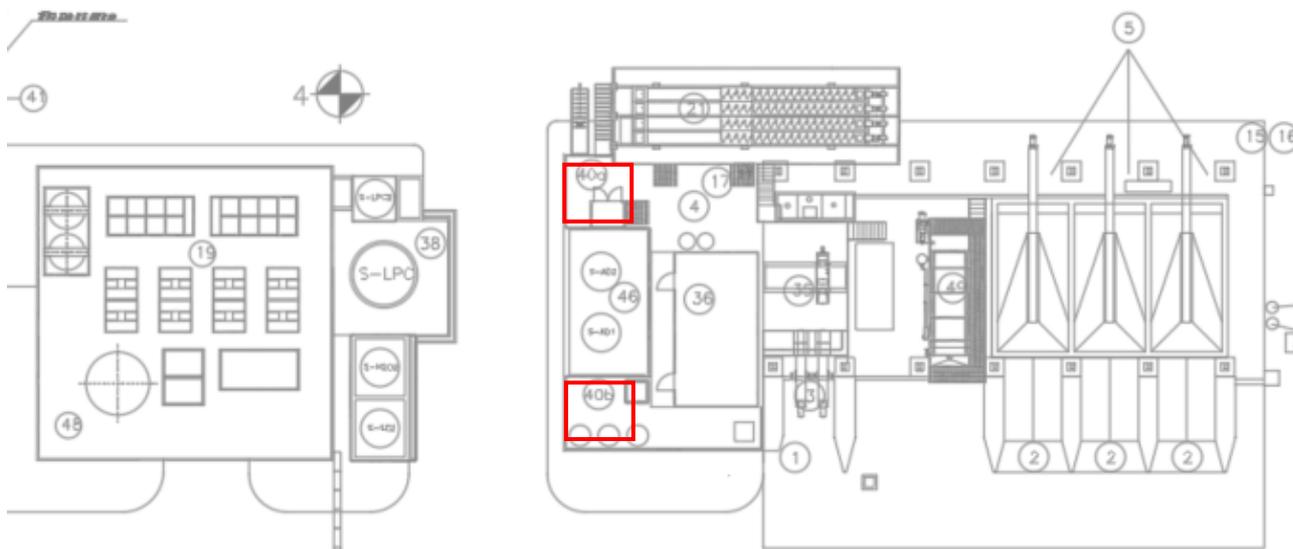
Stralcio planimetria depositi e stoccaggi con indicazione (in rosso) delle vasche E (40a) ed F (40b)
